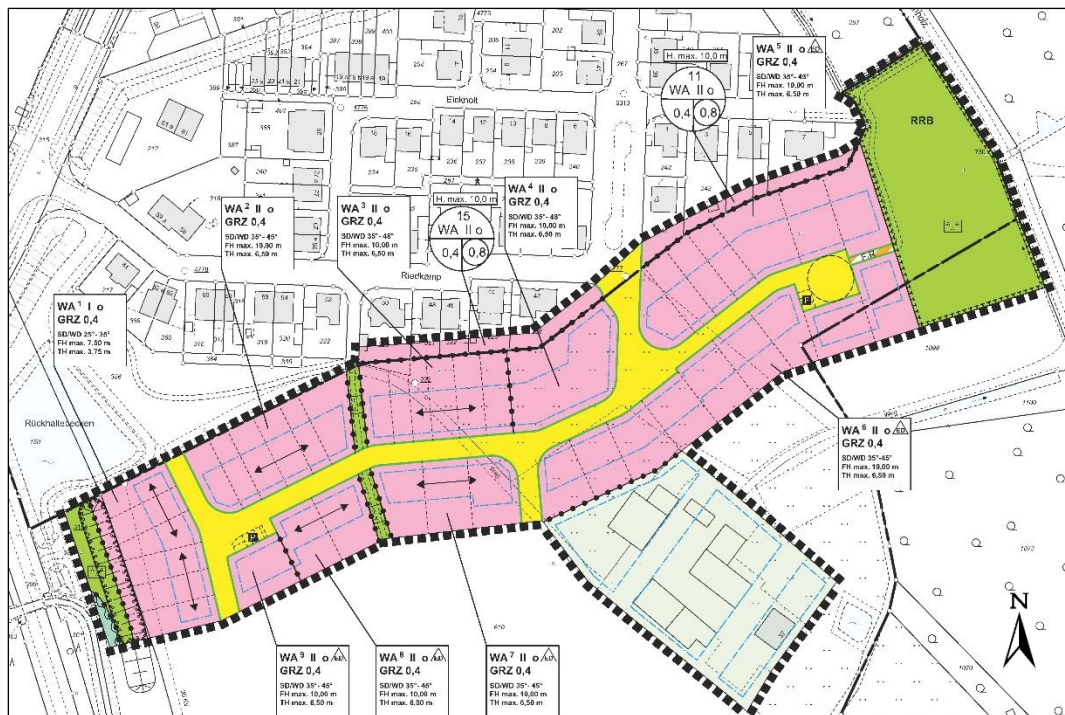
Planzeichnung zum Bebauungsplan (Ausschnitt, Entwurf) /10/
